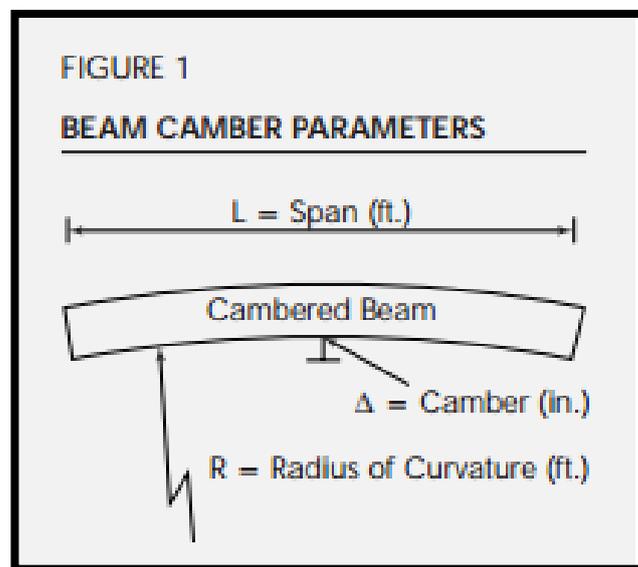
Camber para Viga Glulam-Engineerd Wood Systems. Fuente: Sitio web.
